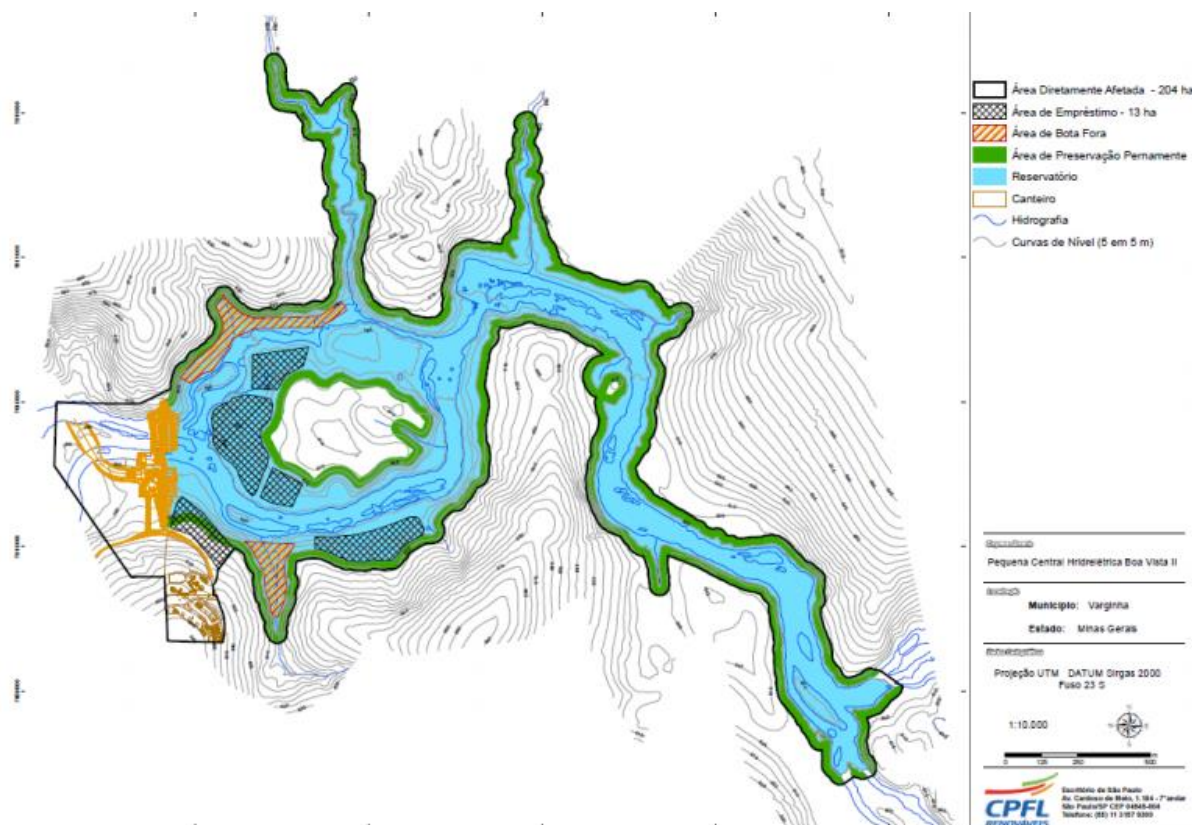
Imagem das futuras instalações da PCH Boa Vista II. Fonte PU 0209633/2017
